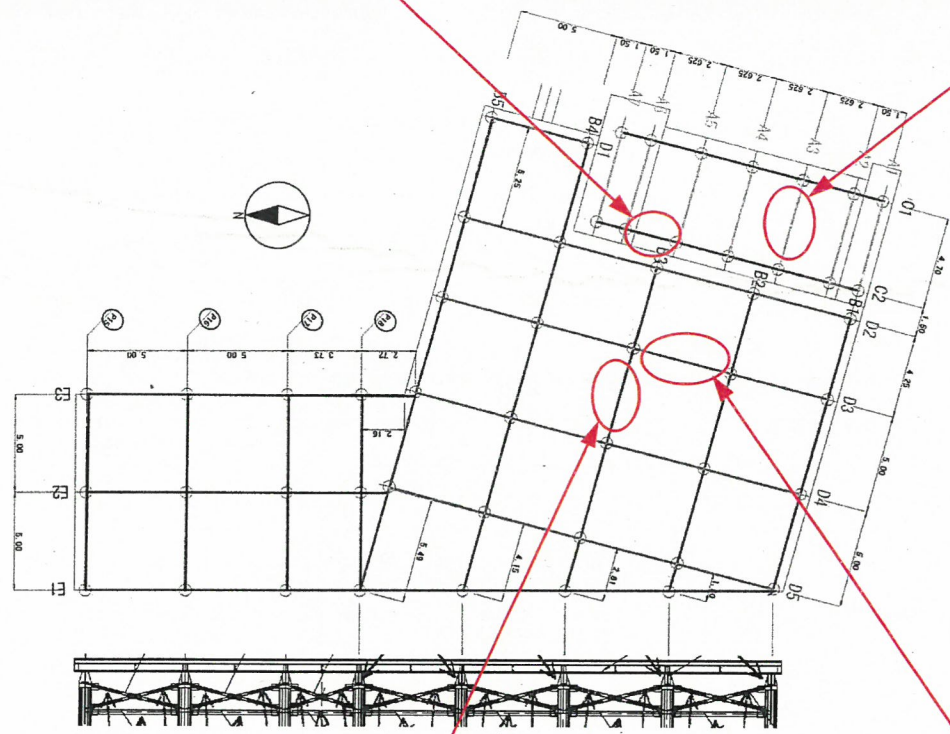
搬出入施設・車両乗降部 平面・断面図 (下部工：海水面より上)
